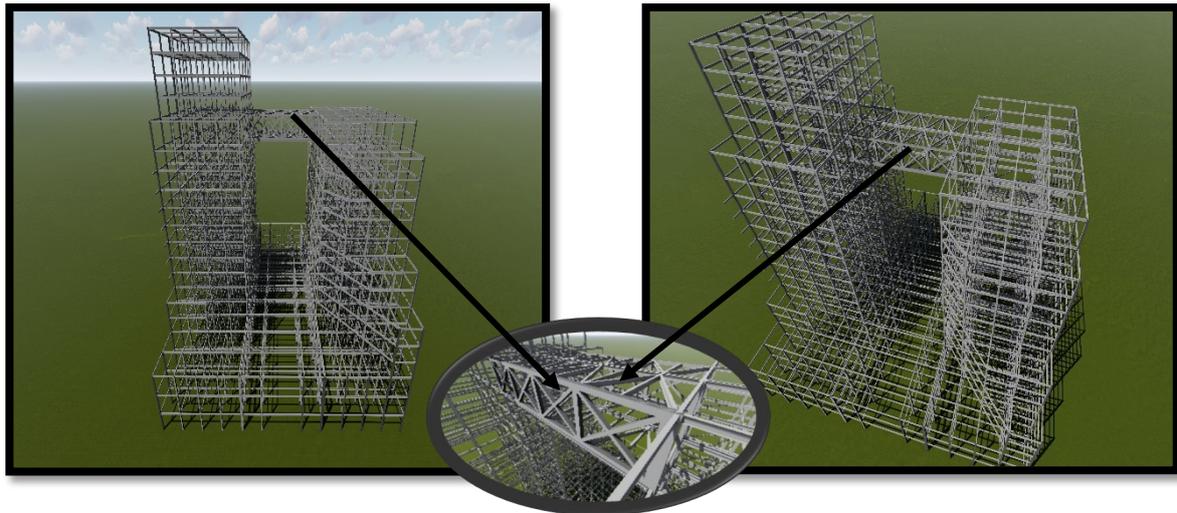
vu 3D de la trame structurelle du projet (source : auteur).
